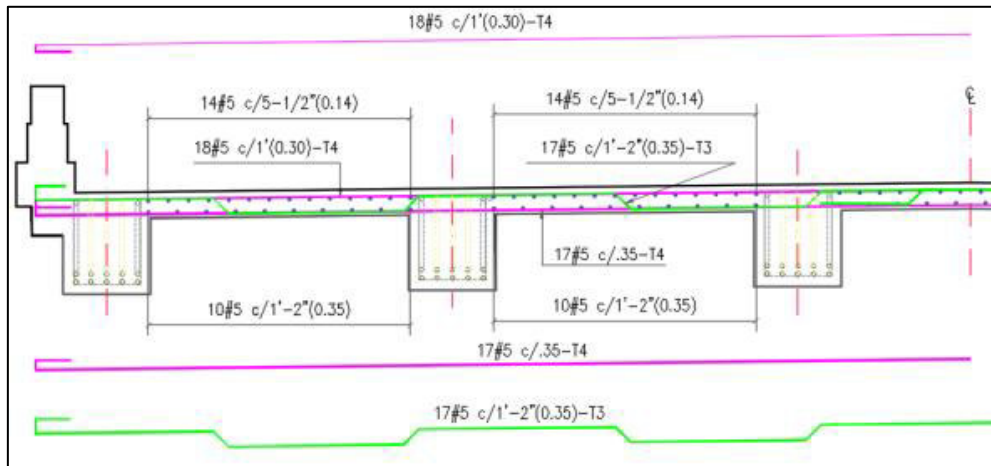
Sección transversal puente No 1- refuerzo losa - transcrita
